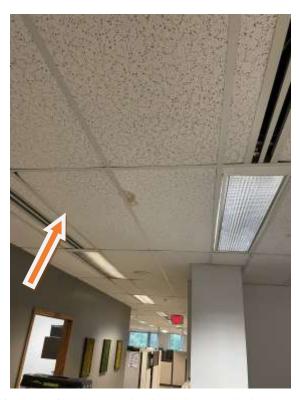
Les tuiles acoustiques (2 pi x 4 pi) constituant le plafond suspendu dans le secteur des travaux au 4^{ème} étage du Pavillon DE ne contiennent pas d'amiante (*Échantillon* : Pav D-SFA-4^e-PF-TA-2)
